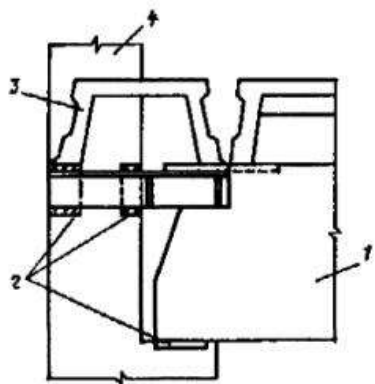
Объединение каркаса здания с помощью ригелей и плит перекрытия:
